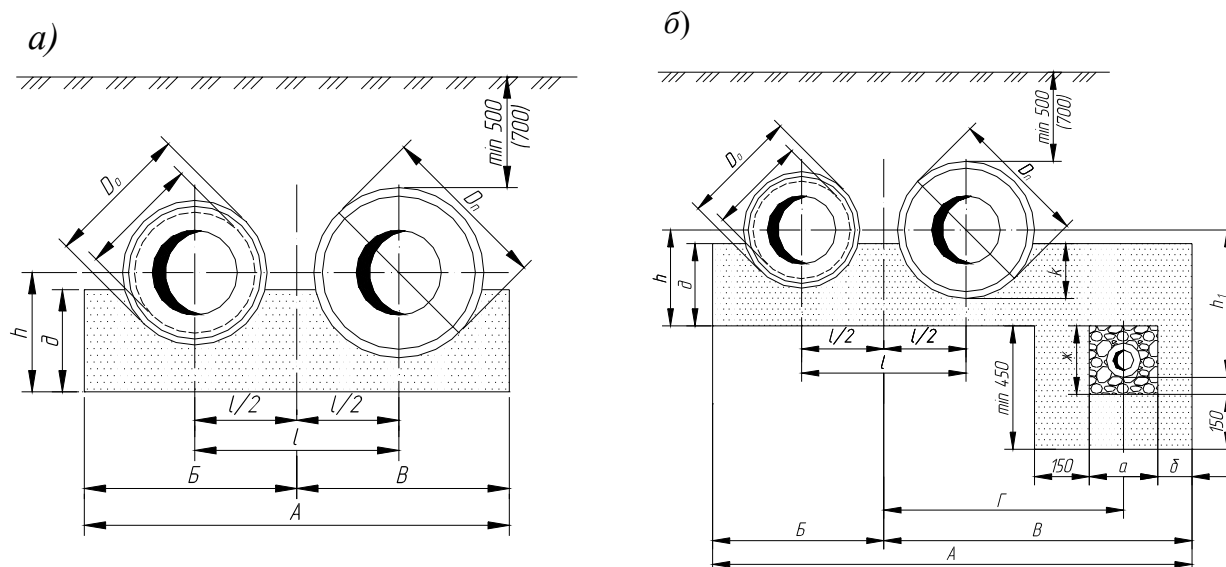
Бесканальная прокладка тепловых сетей: а – в сухих грунтах; б – в мокрых грунтах с попутным дренажем
